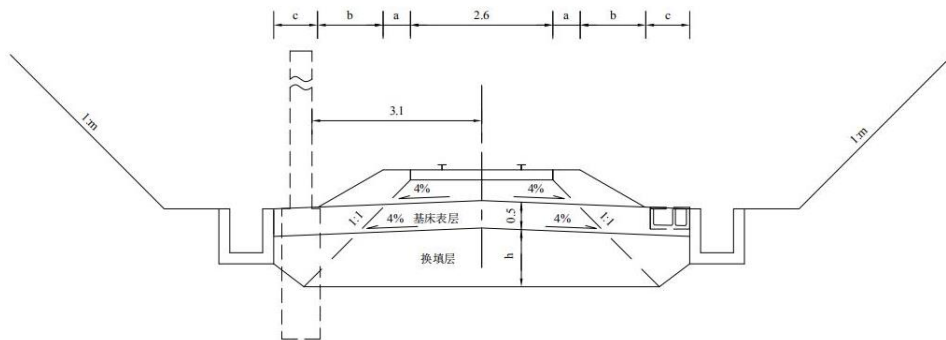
有砟轨道单线非硬质岩路堑横断面图 (单位: m)
